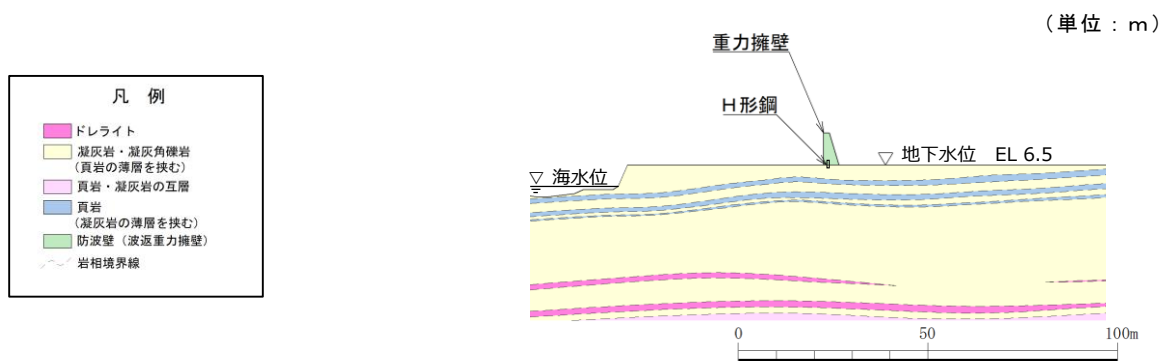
防波壁 (波返重力擁壁) の横断面図 (⑥-⑥断面)
